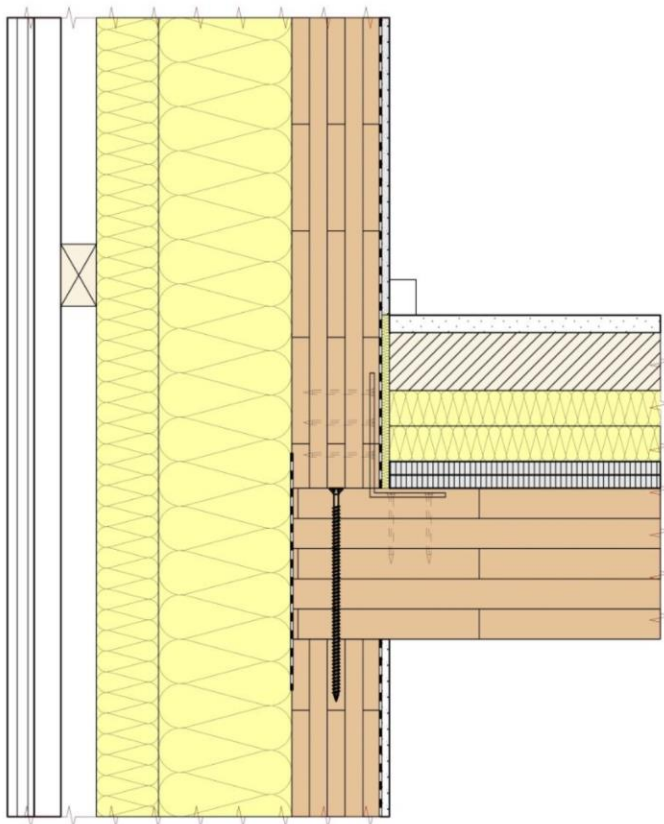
Exemples de jonction plancher/mur sur mur CLT
